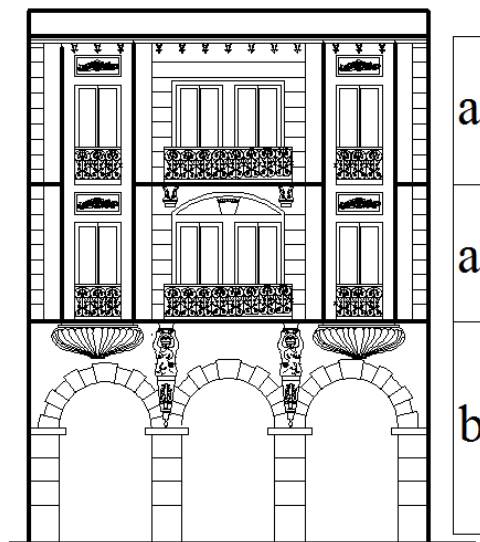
Hauteur de la façade l'immeuble d'habitation
